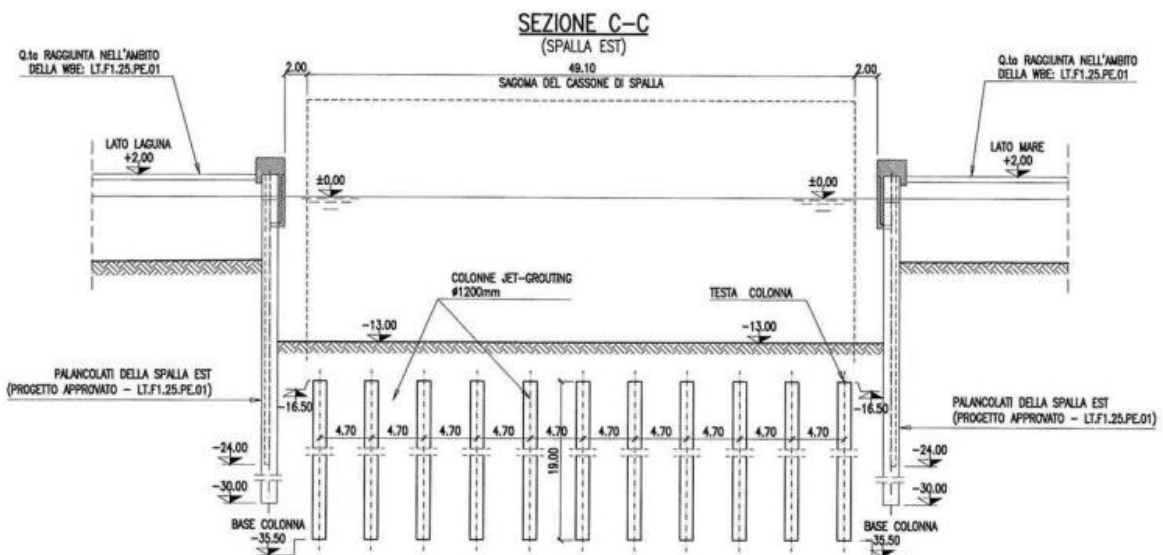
Schema jet grouting per il cassone di spalla Est; estratto dagli elaborati grafici AS BUILT.
